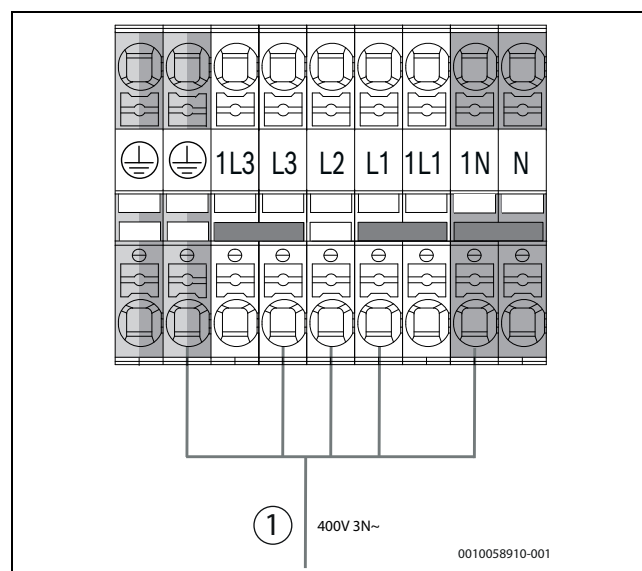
Elmatning standard från fabrik (6 kW, 8 kW, 13 kW, 17 kW)
